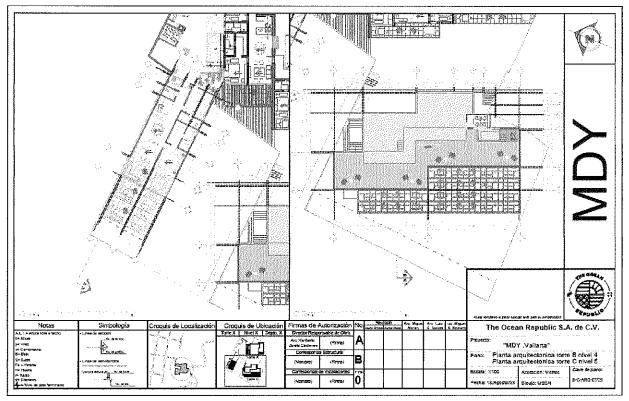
Planta arquitectónica torre B nivel 4. Planta arquitectónica torre C nivel 5
